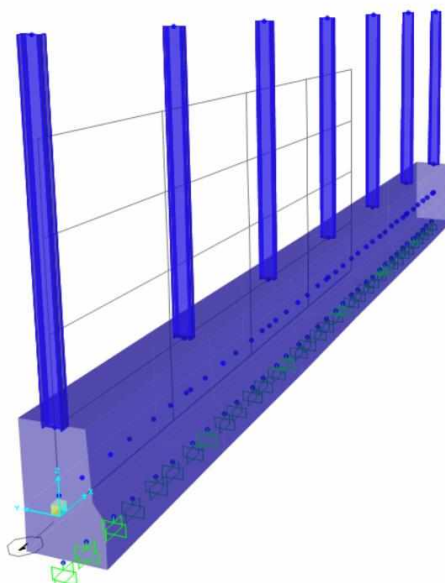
Modello di calcolo muro FOA TIPO 1 con elementi beam
